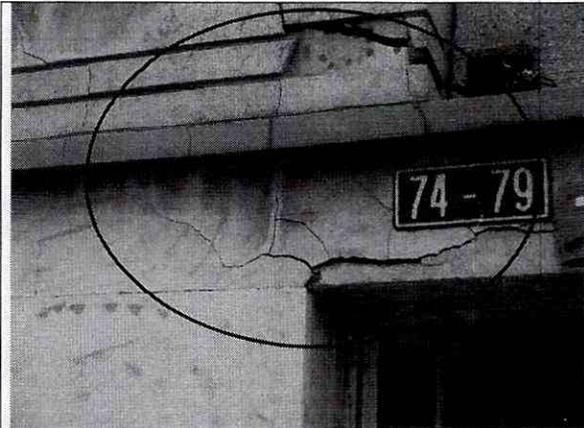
Grietas y desprendimientos de acabados en muro de fachada
